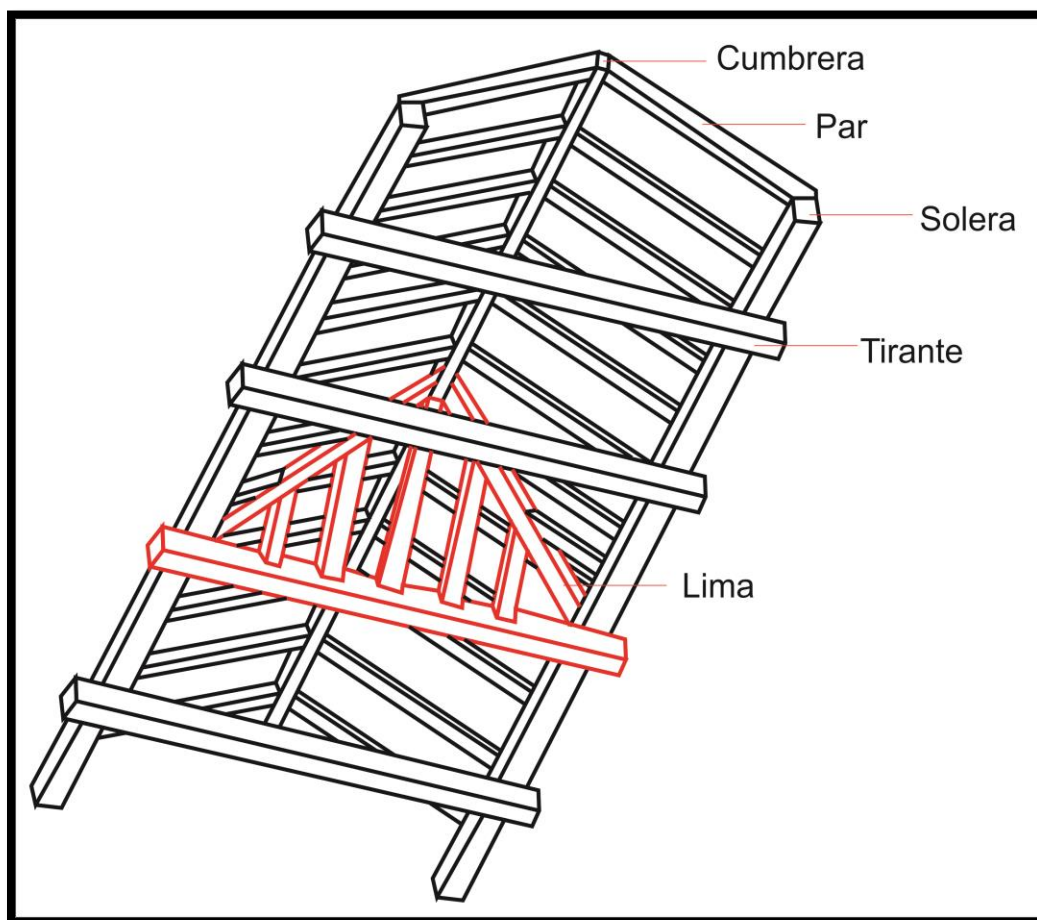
En rojo la estructuración de los planos de cielo raso dispuestos en la cubierta.
